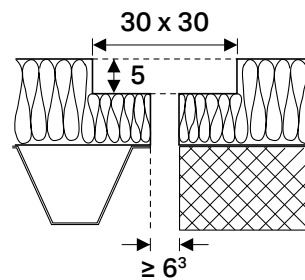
Maße bei Einbau in gedämmten Dachaufbau
